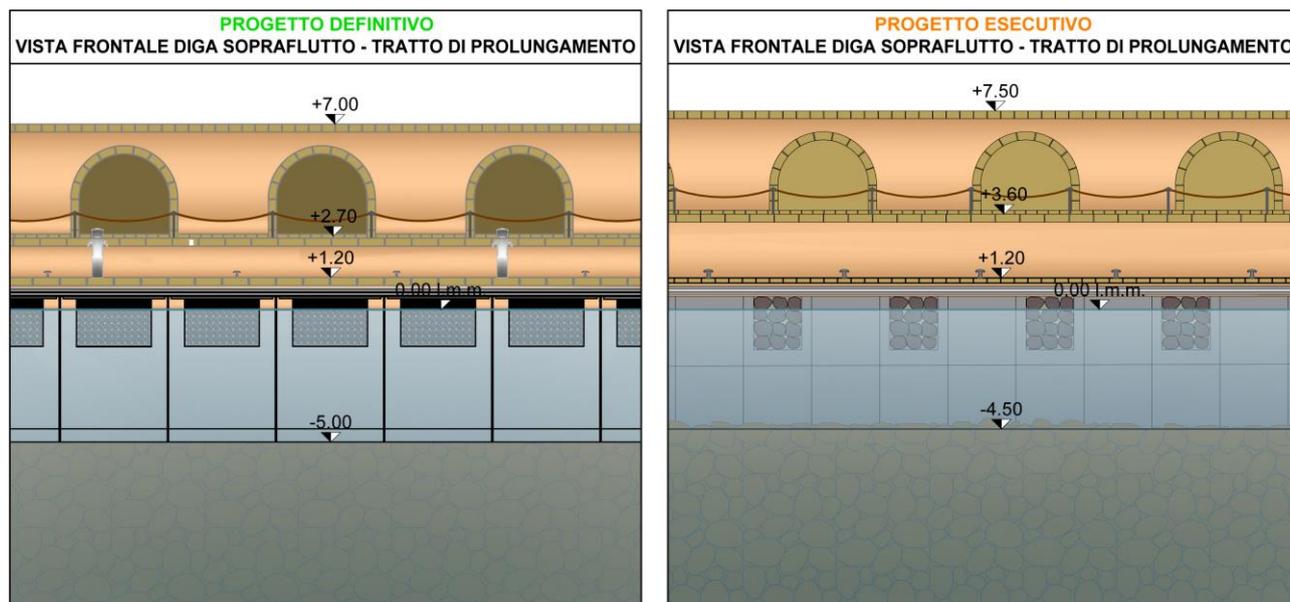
Vista frontale con raffronto quote pavimentazione diga sopraflutto
